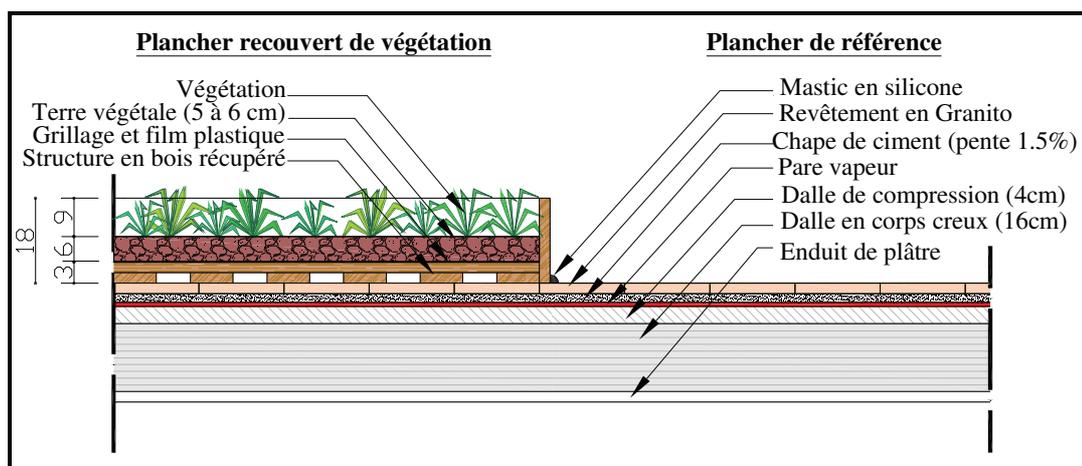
Coupe schématique sur le plancher de référence et la toiture végétale
